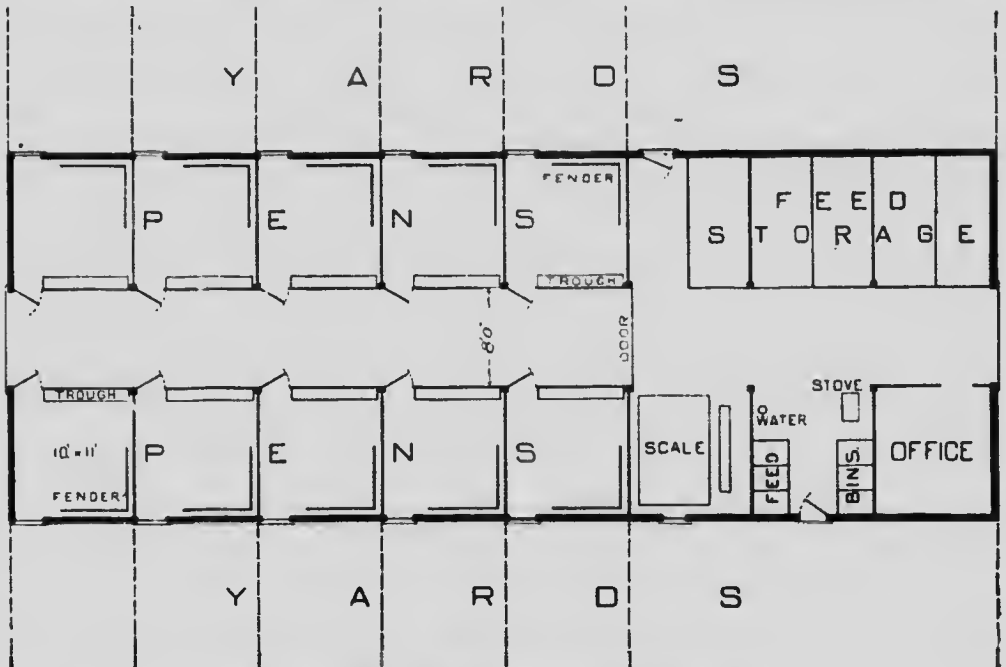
Plan d'un plancher d'une porcherie bien éclairée.
